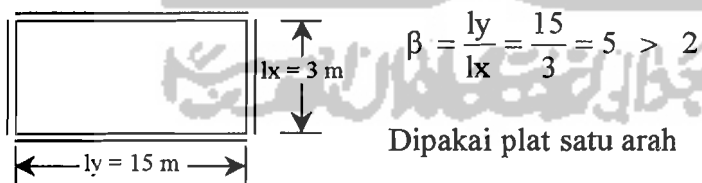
Denah Penempatan Balok Anak Tipe D
